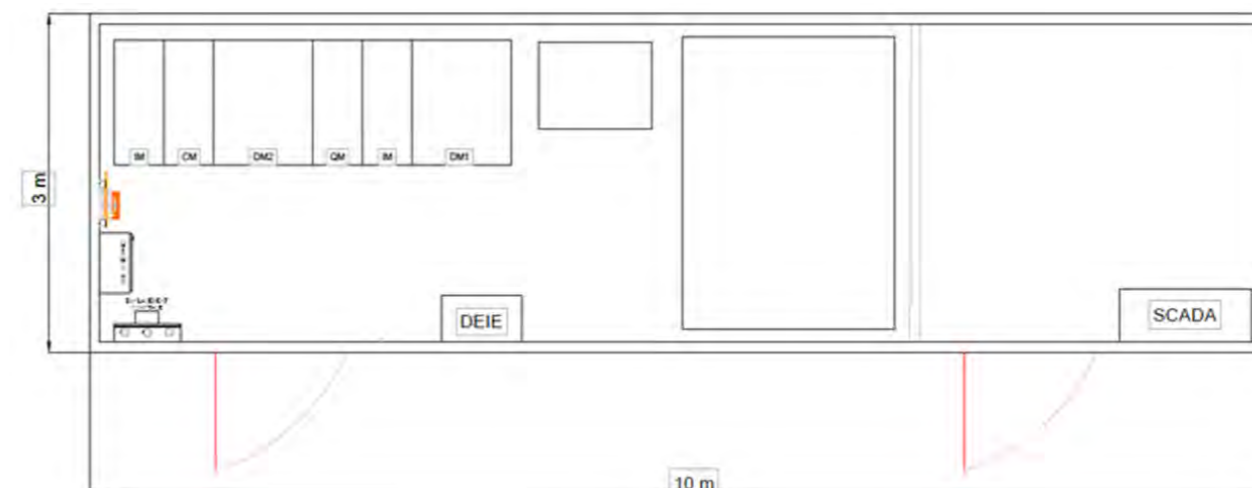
Exemple de plan de masse du poste de livraison (Source : VALECO)
